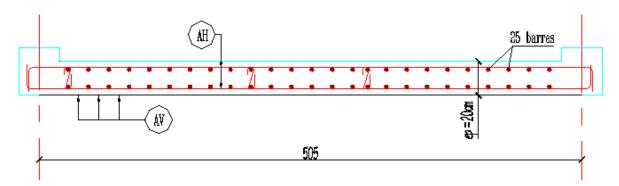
ferraillage de voile type 01 (L=5.05 m)
